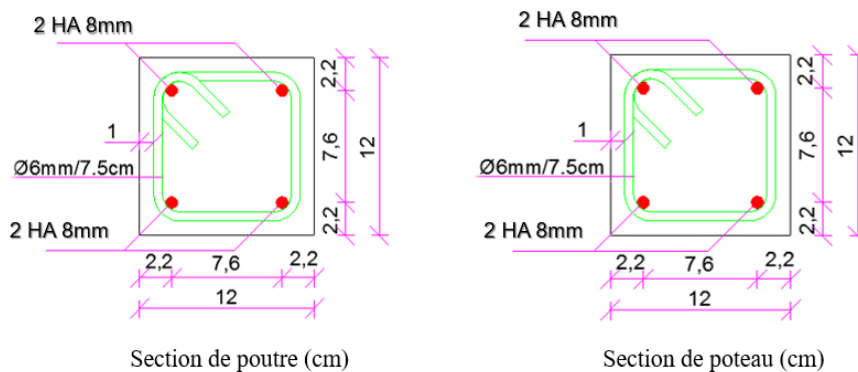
Géométrie et ferrailage considérés pour l'assemblage extérieur poutre-poteau
